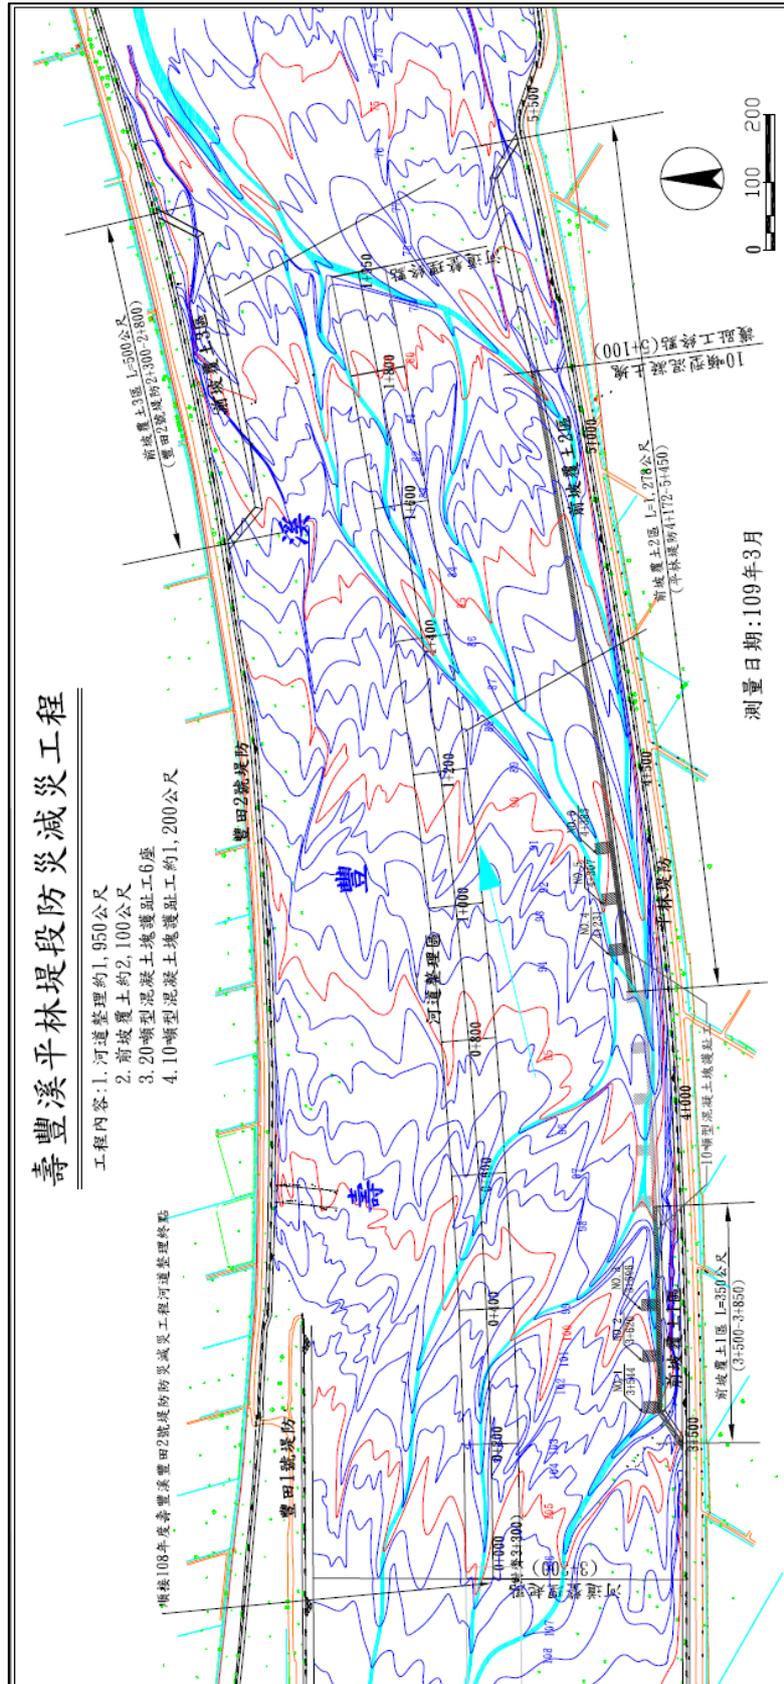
壽豐溪平林堤段防災減災工程平面圖(第 2 期)
